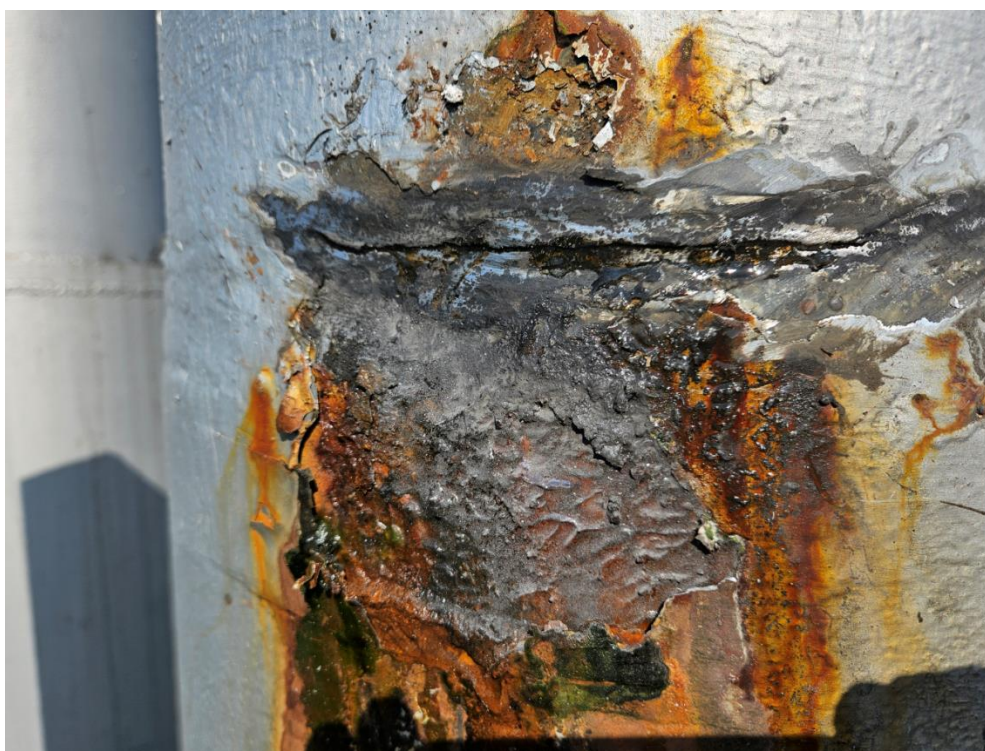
Pęknięcie murku przy schodach o szerokości 8mm
